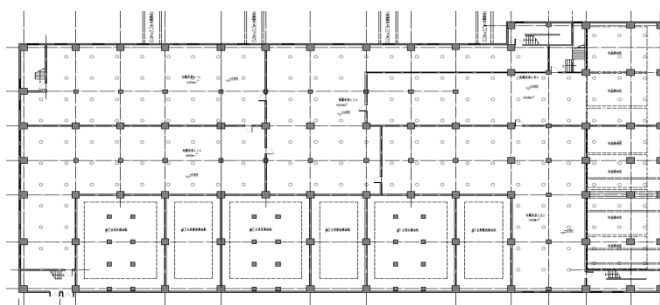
TJ-220-A2-4 方案电缆夹层悬挂式超细干粉平面布置图
